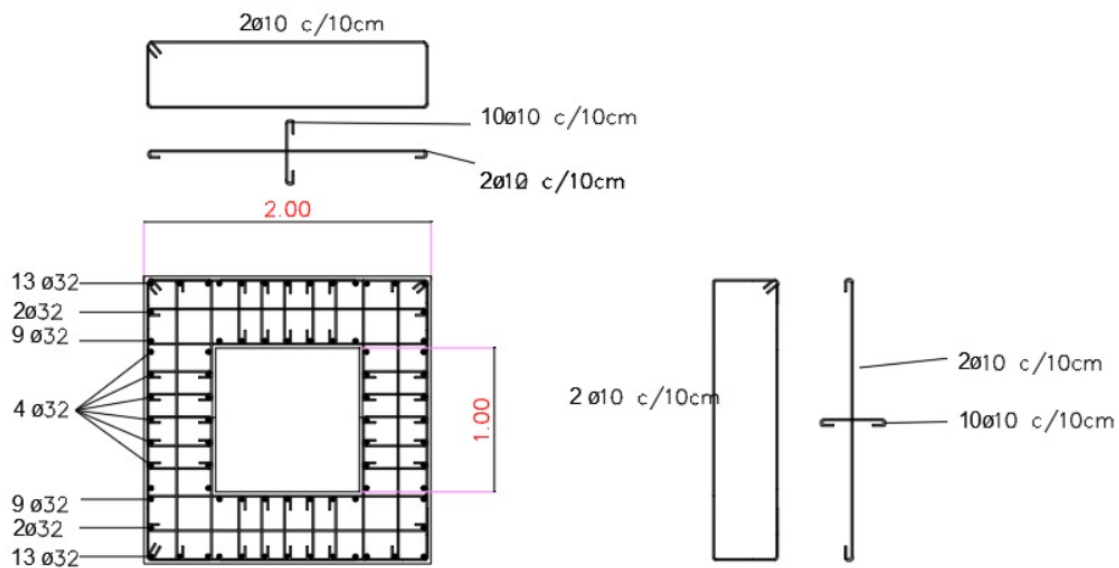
Armadura transversal en las zonas no extremas de la parte inferior de las pilas (H = 2,6 m a H = 13,4 m)
